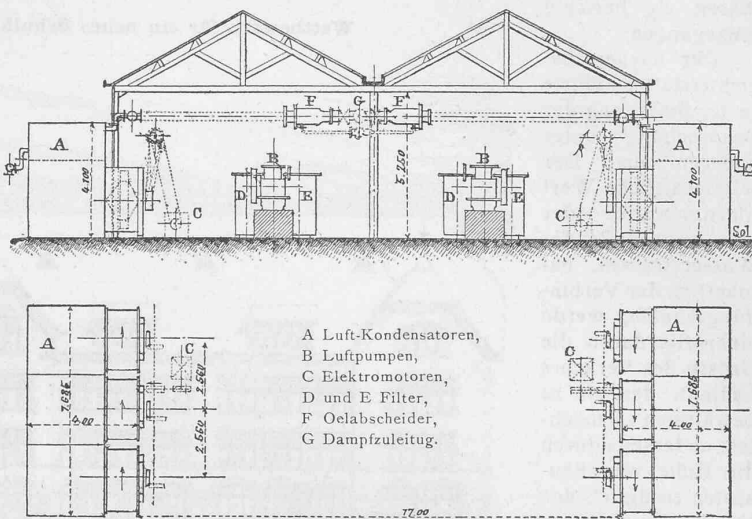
Grundriss und Schnitt. — Masstab 1:250.
